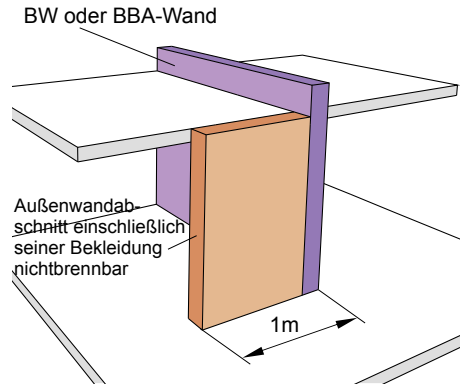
Alternative zu Bild 5.10.3-2
